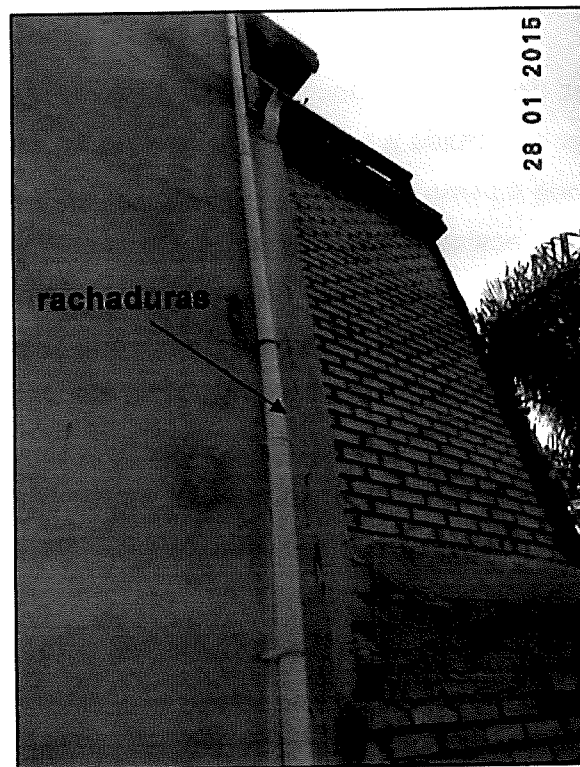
Rachaduras em casa localizada ao lado da construção do empreendimento.
